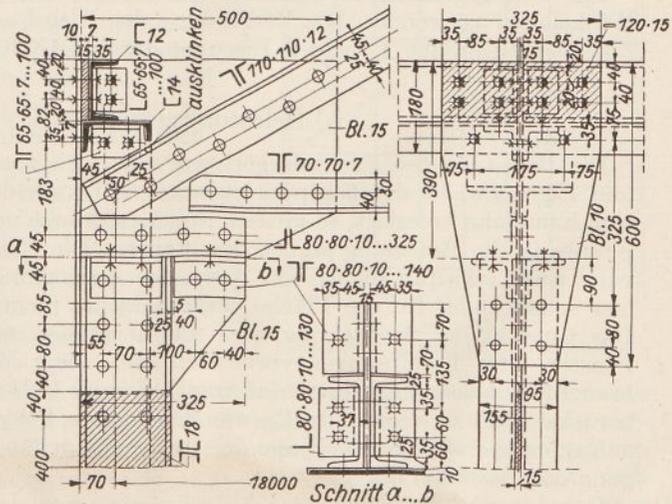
Rahmen für eine Stahlfachwerkwand.
